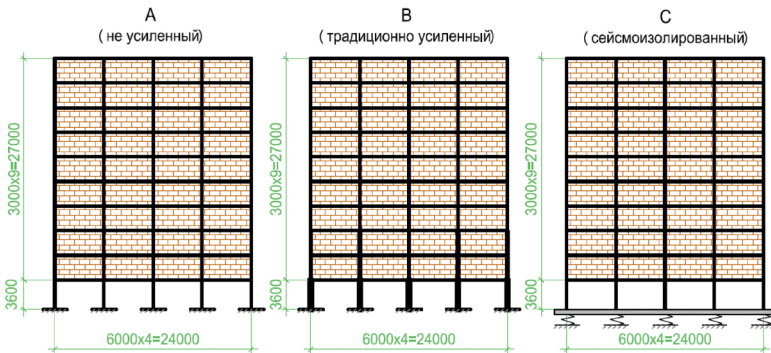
Схема поперечного каркаса ЖБКНИ здания
